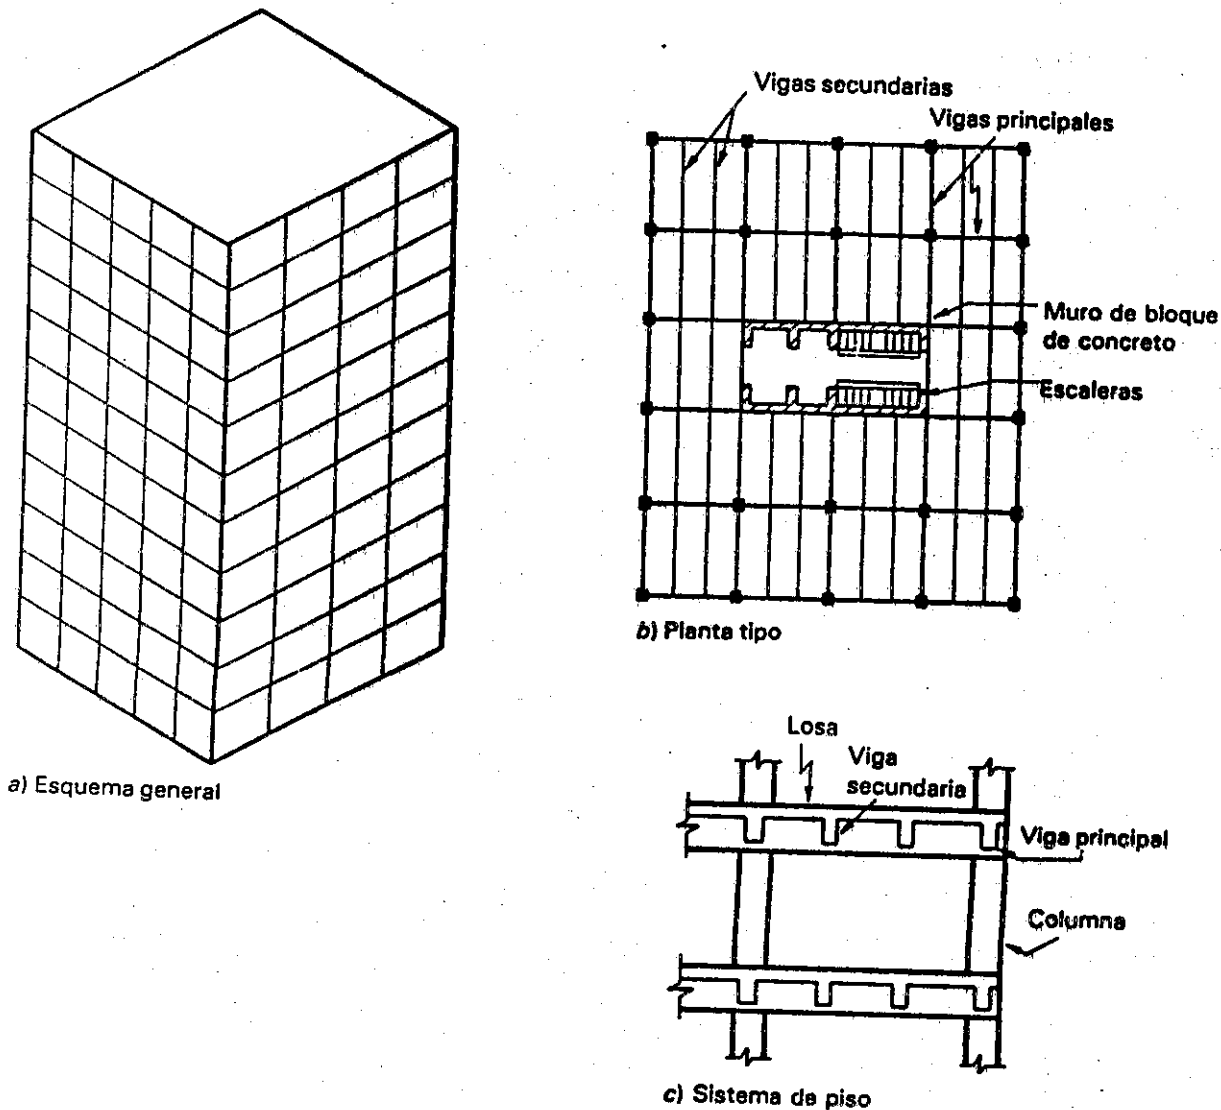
ESTRUCTURACIÓN DE UN EDIFICIO TÍPICO DE VARIOS PISOS. (Adaptado de Diseño estructural, Roberto Meli).
